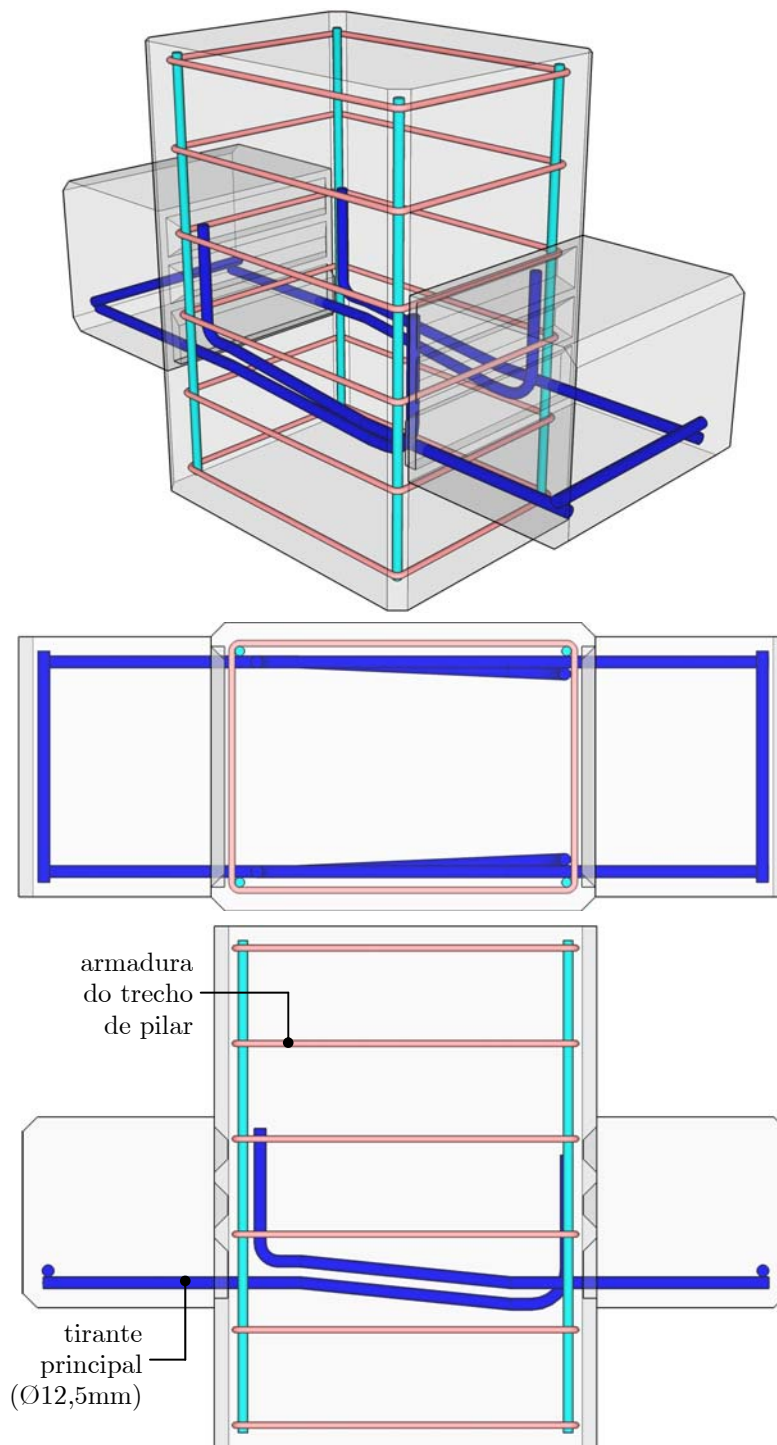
Detalhes das armaduras do modelo MBS1.
